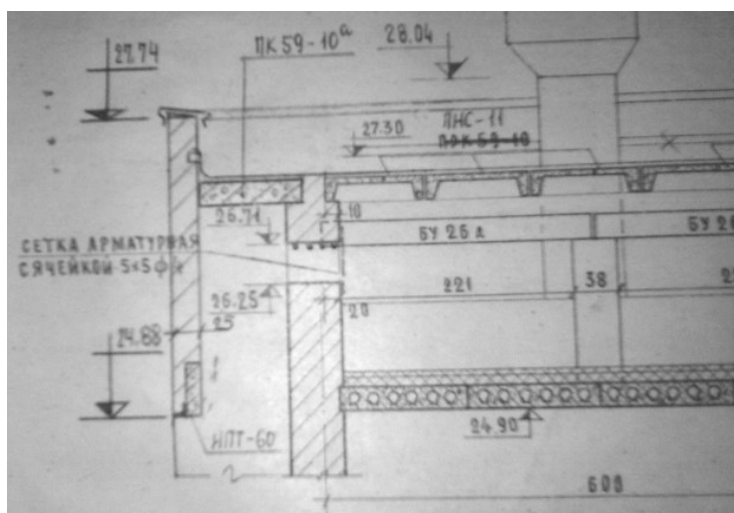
Конструкция ограждения лоджии 9-го этажа
